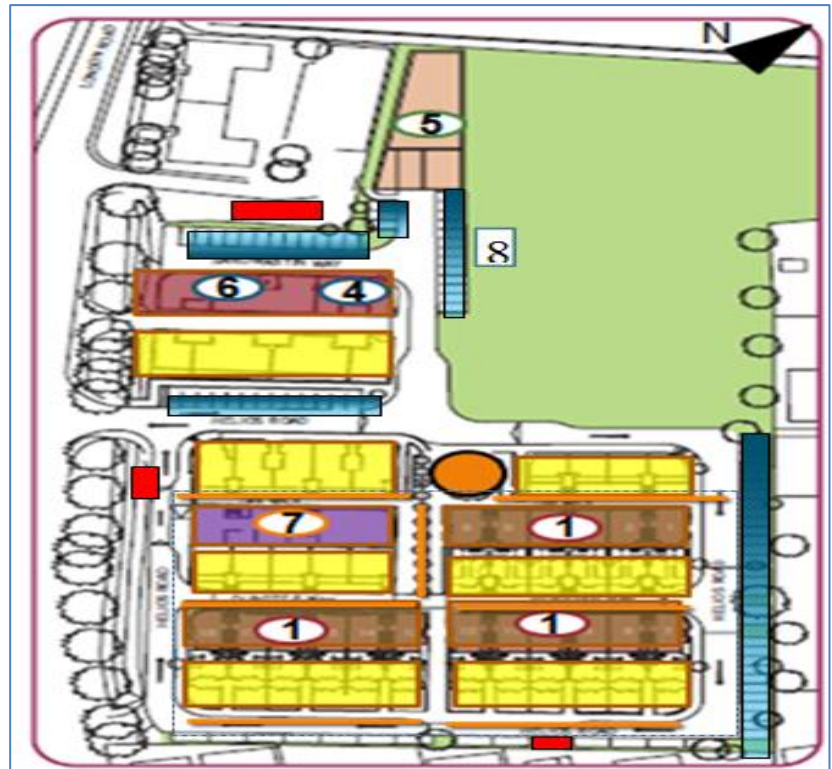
Plan de Bedzed. éch : 1/1000 (traité par l'auteur).
